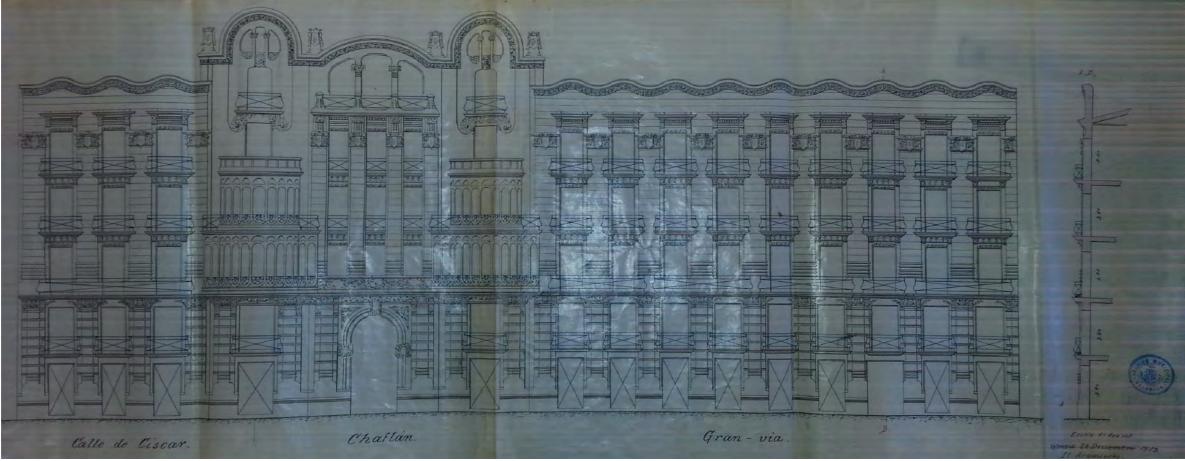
Fachada del Edificio Chapa Nº65 extraído del proyecto original de 1913 del Archivo Histórico de la plaza Tetuan
